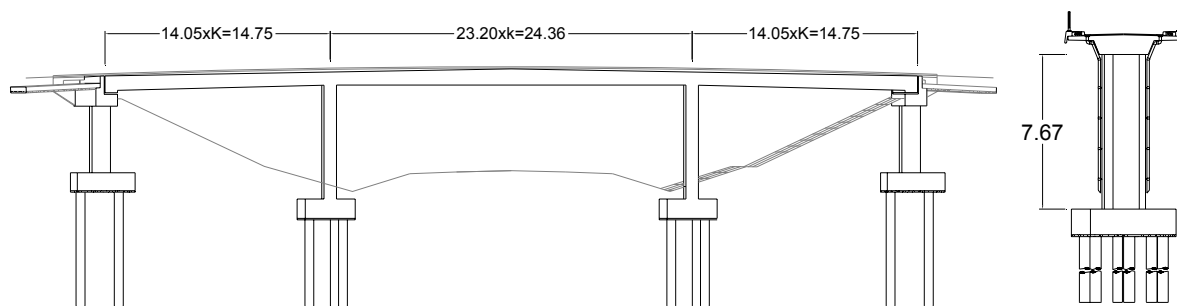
Corte Longitudinal e Transversal de PS12D
